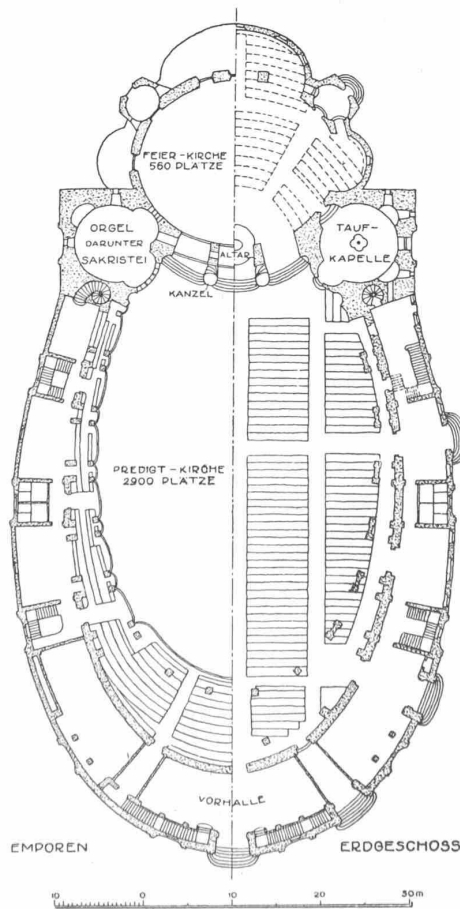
u. 2. Raumbild und Grundriss einer „Gedächtniskirche“. Entwurf von *Martin Elsässer*, Stuttgart.
